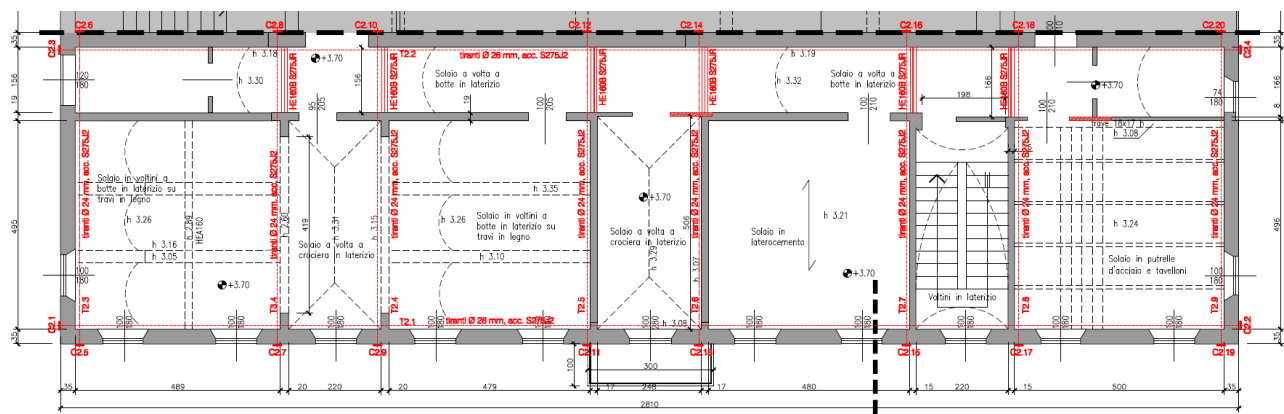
| Pianta piano Primo – Disposizione in pianta di catene
